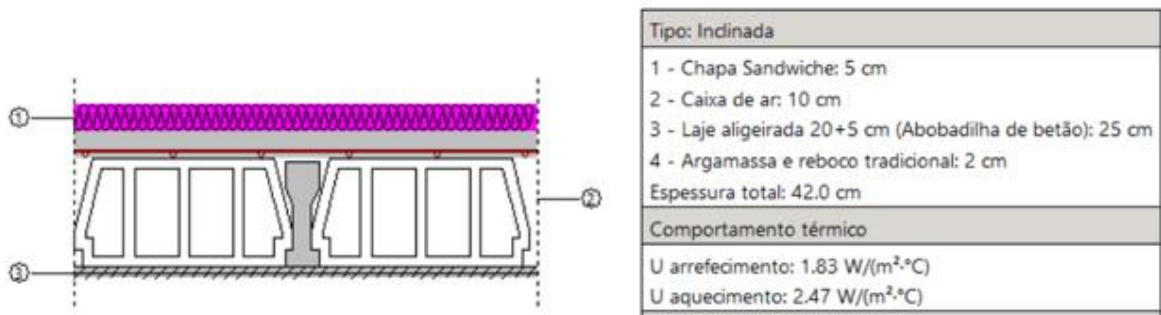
Cobertura em chapa sandwich (CYPE, 2024).
